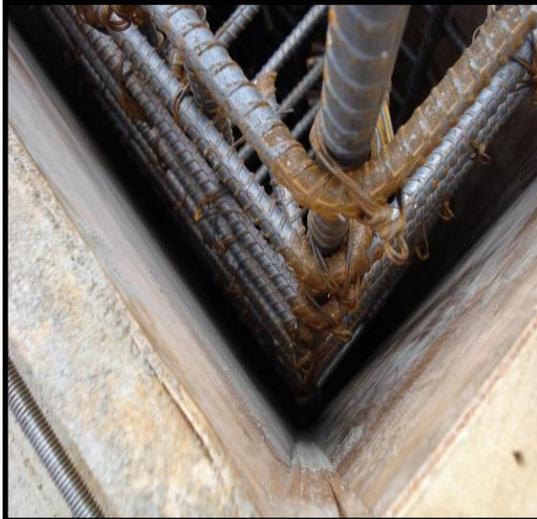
y 4.2 Formaleta de una columna tipo y columna después de ser desencofrada.
